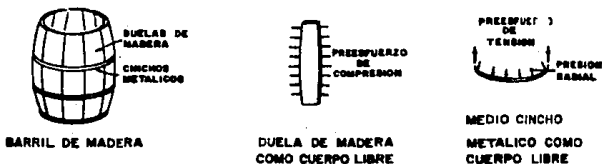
PRINCIPIO DEL PREESFUERZO APLICADO A LA CONSTRUCCION DE UN BARRIL.
